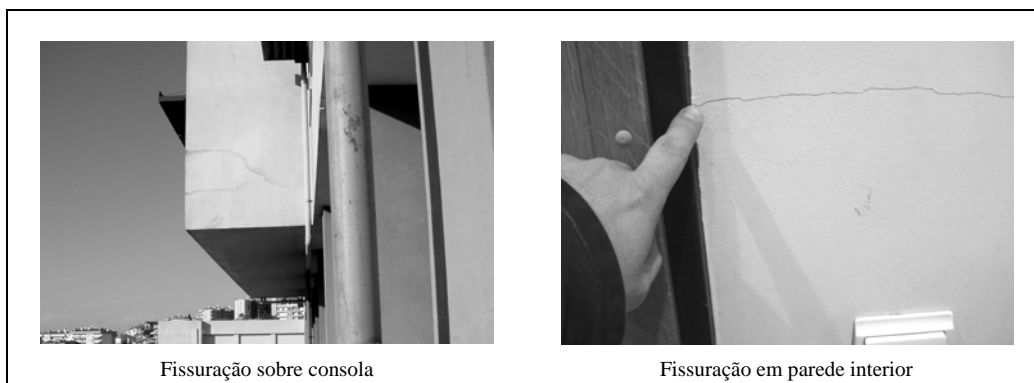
Exemplos de fissuração por deformação excessiva do suporte
